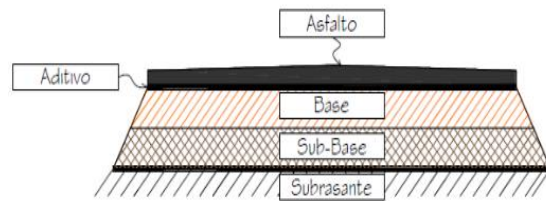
Sección típica transversal pavimento semi-rígido - Fuente: Armijos 2009
